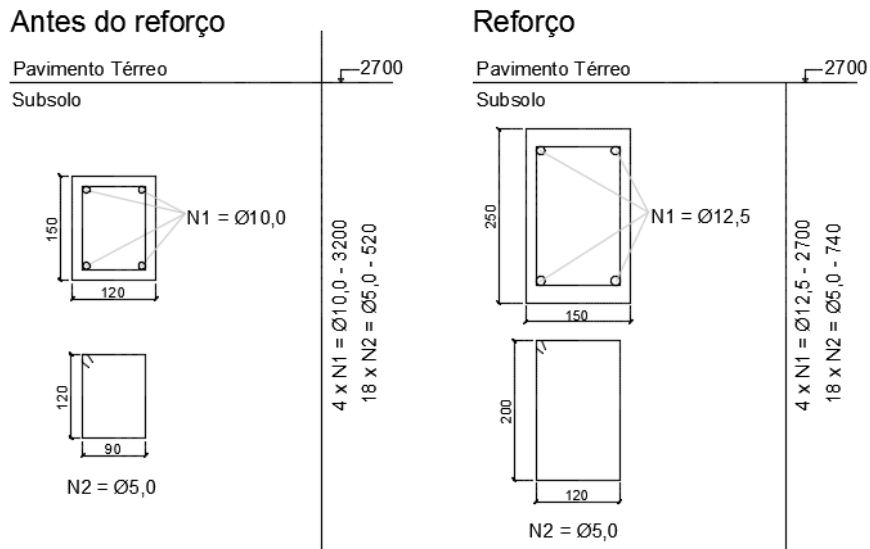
Armaduras de los pilares a reforzar y el refuerzo.
